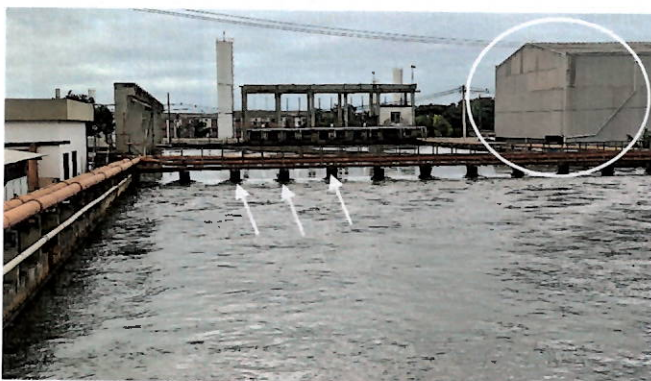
caixa de tranquilização (ao fundo pontos de aplicação de coagulante e unidade de preparação de carvão ativado).
